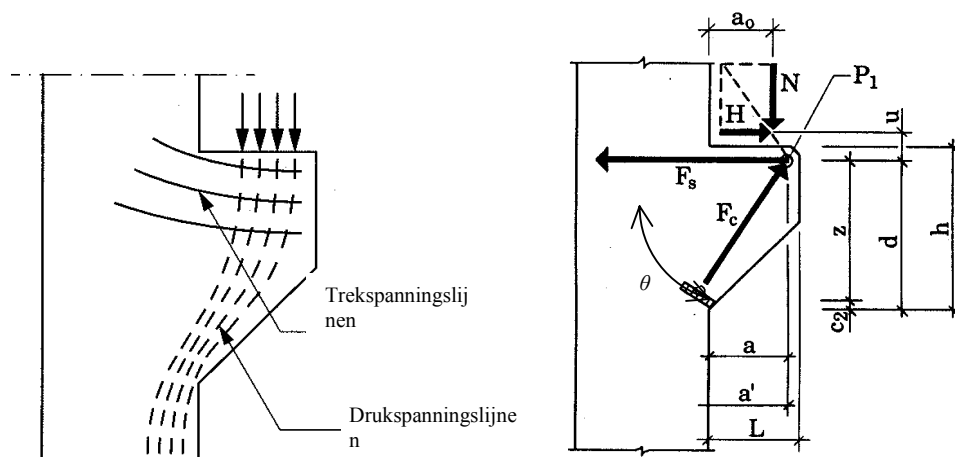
Spanningsverloop en schoorhoekmodel in betonconsoles
